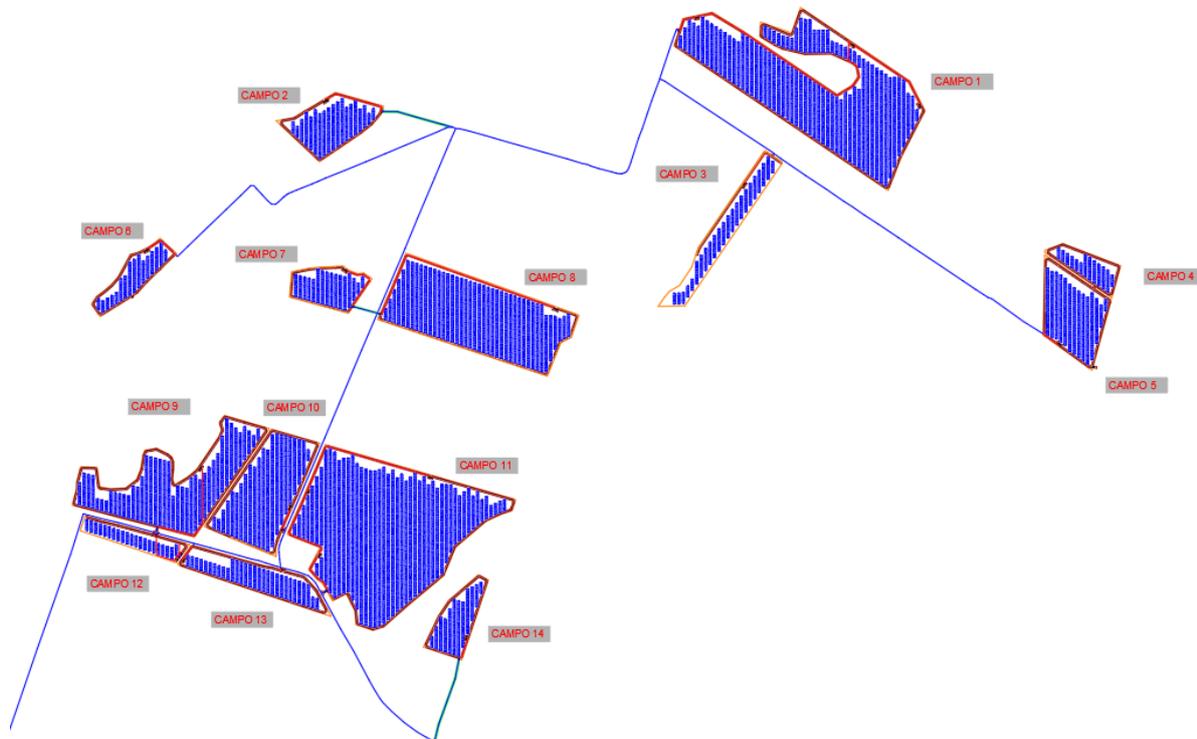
Schema layout dell'impianto – Vista Gruppo 1: da Campo 1 a Campo 14.
